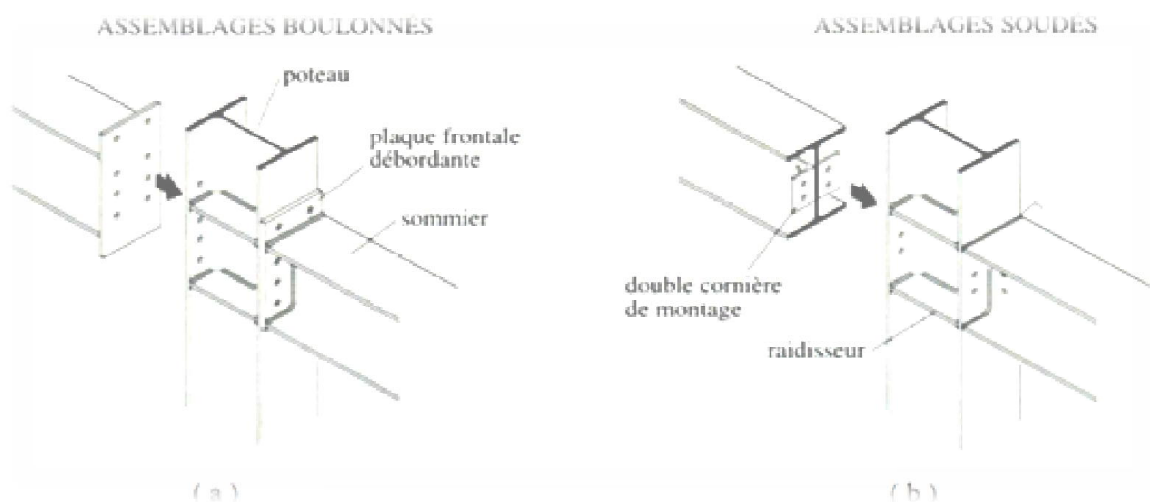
Assemblages articulés (poutre-poteau).
